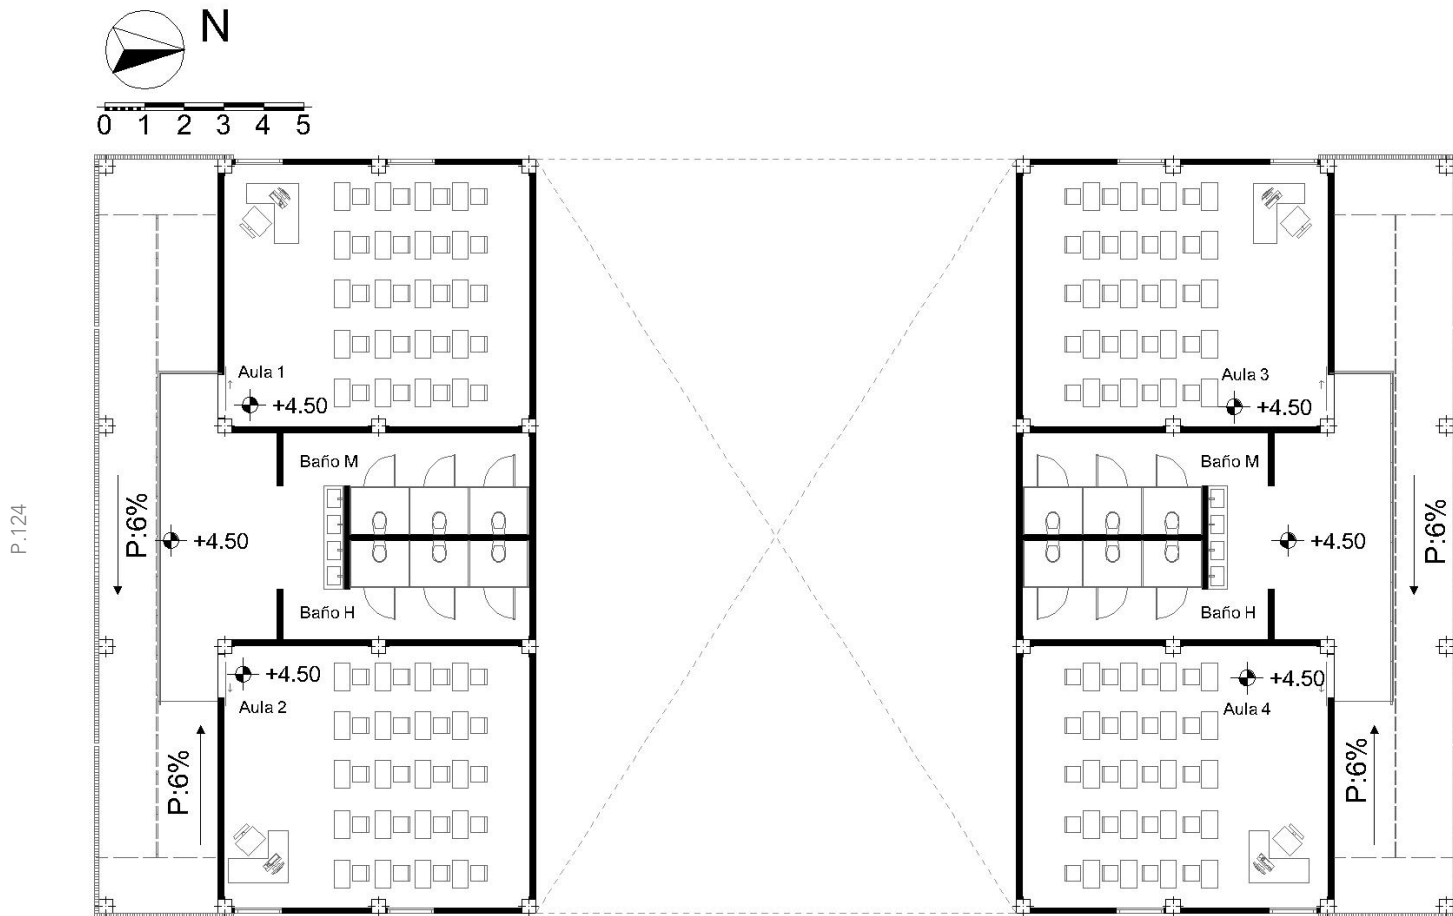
Planta arquitectónica, plataforma 1, planta baja
